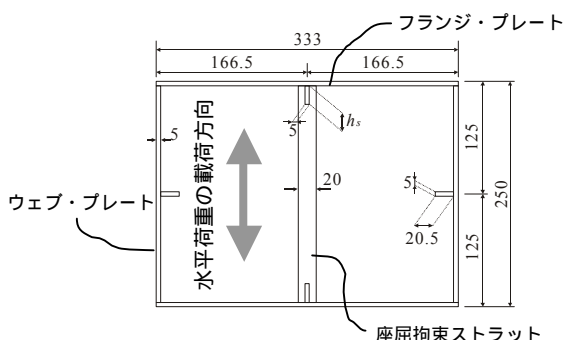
断面図および座屈拘束ストラットの断面方向の設置位置 (寸法単位: mm)
